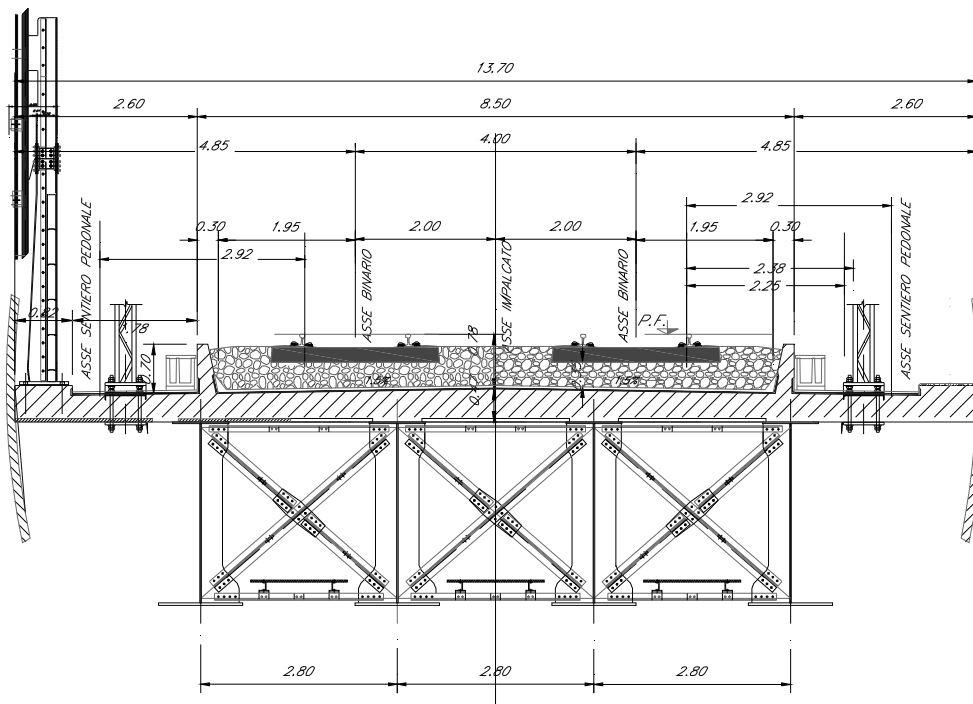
Sezione tipo - Impalcato a struttura mista acciaio calcestruzzo a doppio binario
